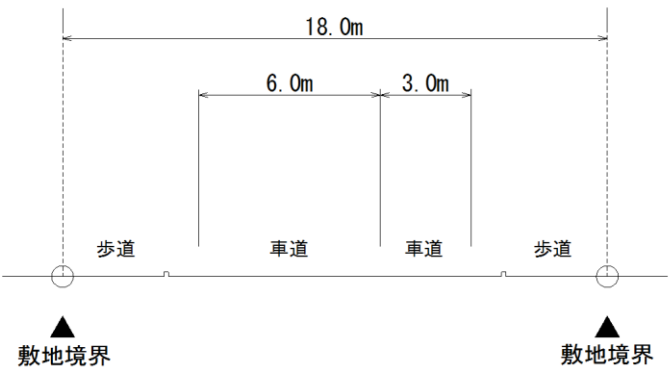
(4) 予測断面図 (D. 市川柏線)
